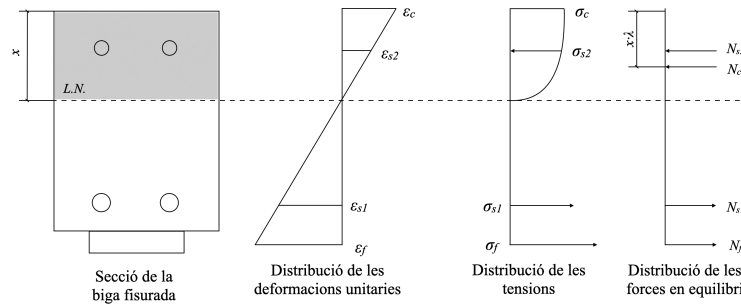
Anàlisi seccional de la biga fissurada.
